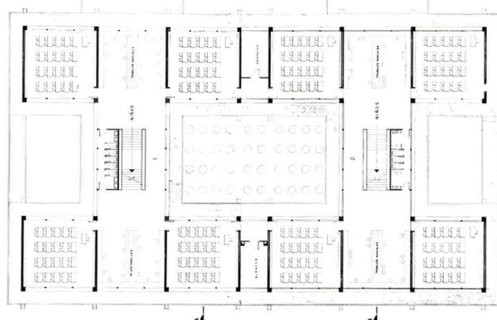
Planta Concurso 1966 “Proyecto Tipo”
